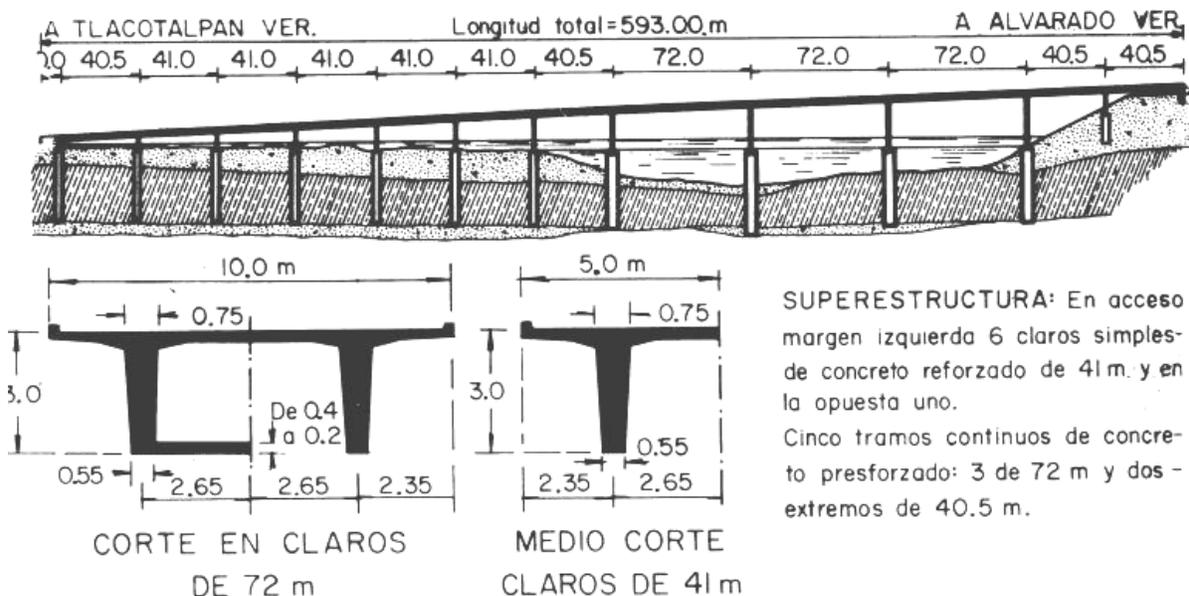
Plano esquemático del Puente Tlacotalpan.
